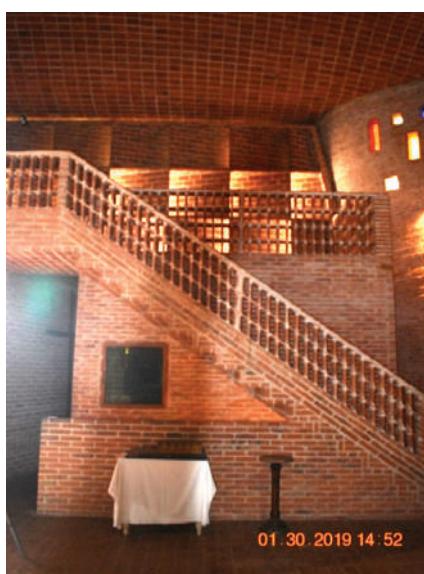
Vista da escada que sobe ao mezanino em tijolo armado. Na parte de cima, a fachada vista por dentro. (*-5).
